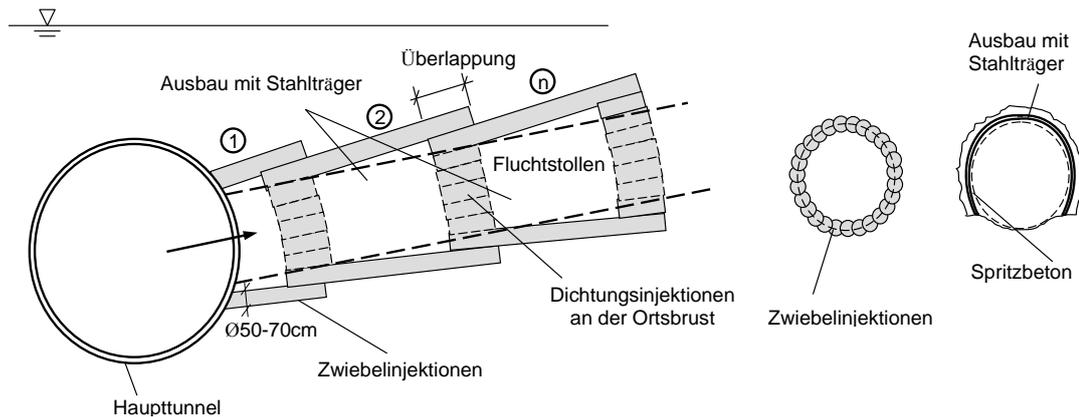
Injektionszwiebel aus dem Tunnel – Horizontal-HDI
